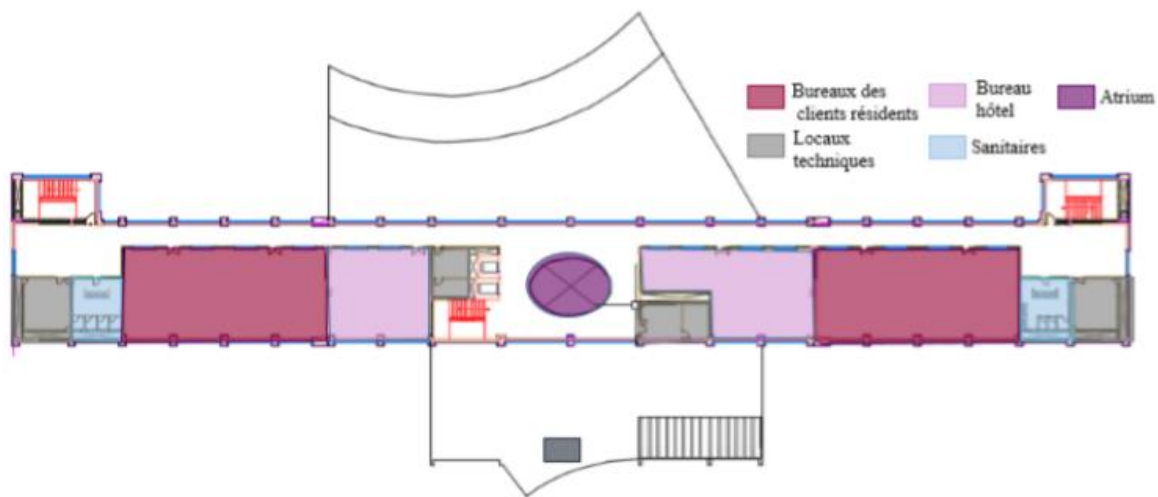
Plan 1<sup>er</sup> Etage (ANPT)
